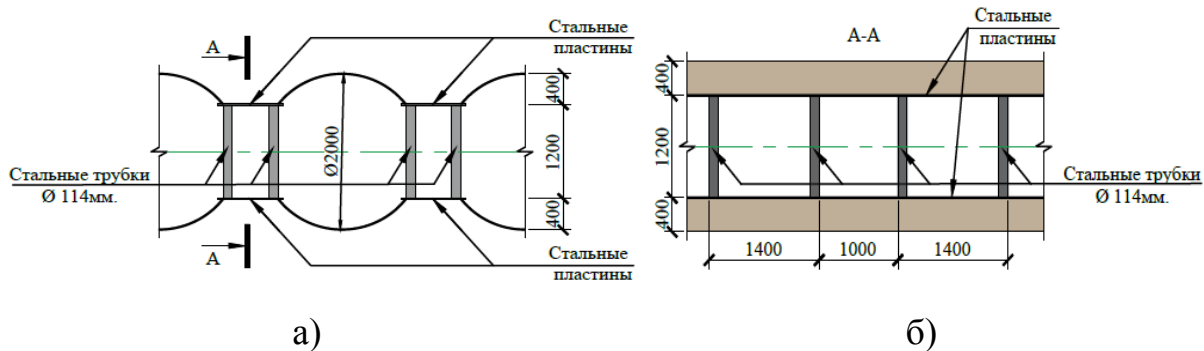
Схема разрезки труб и их соединений с помощью внутренних трубок и пластин: а) поперечное сечение, б) разрез А-А
